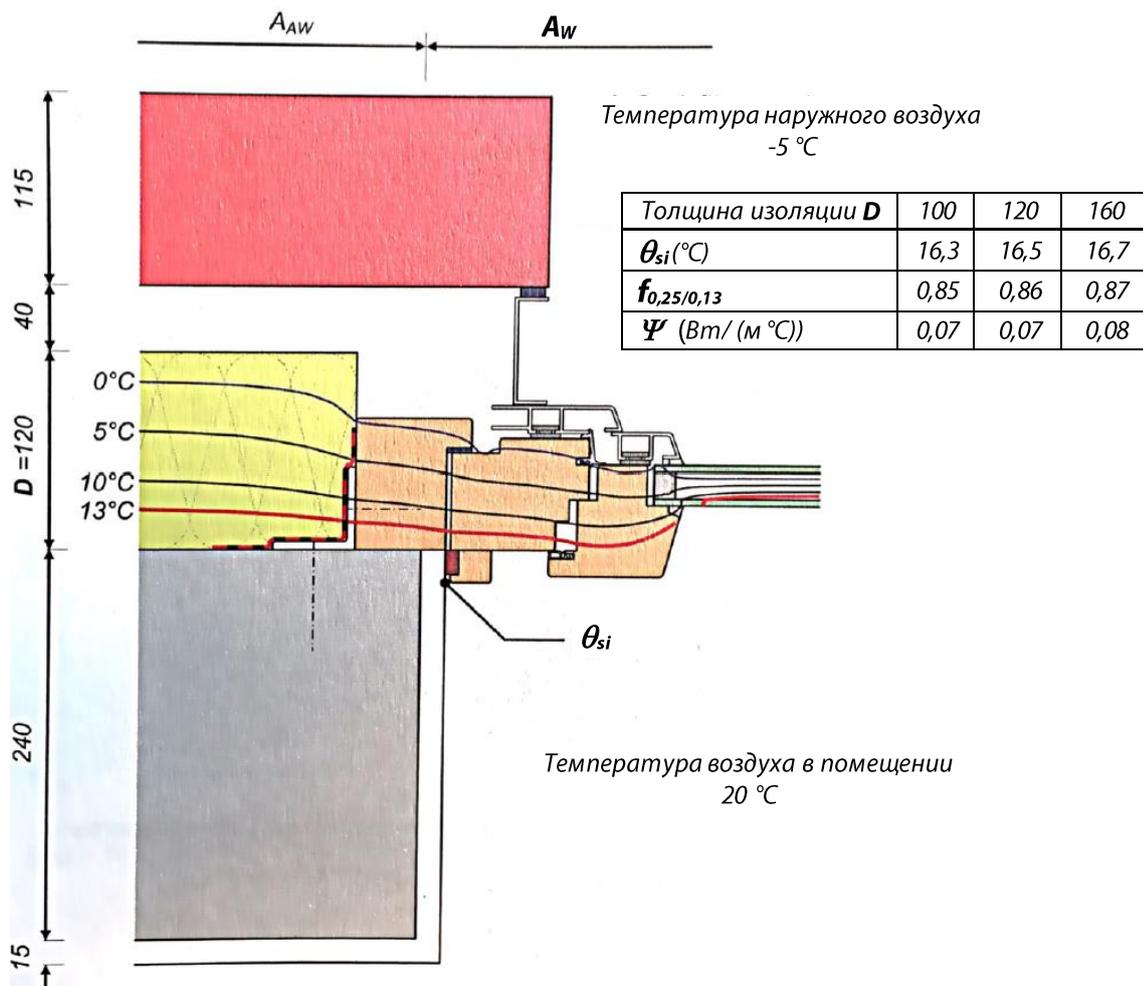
Двухслойная наружная стена с изоляцией и воздушной прослойкой, деревянное окно (сосна) с металлической накладкой и обечайкой.
